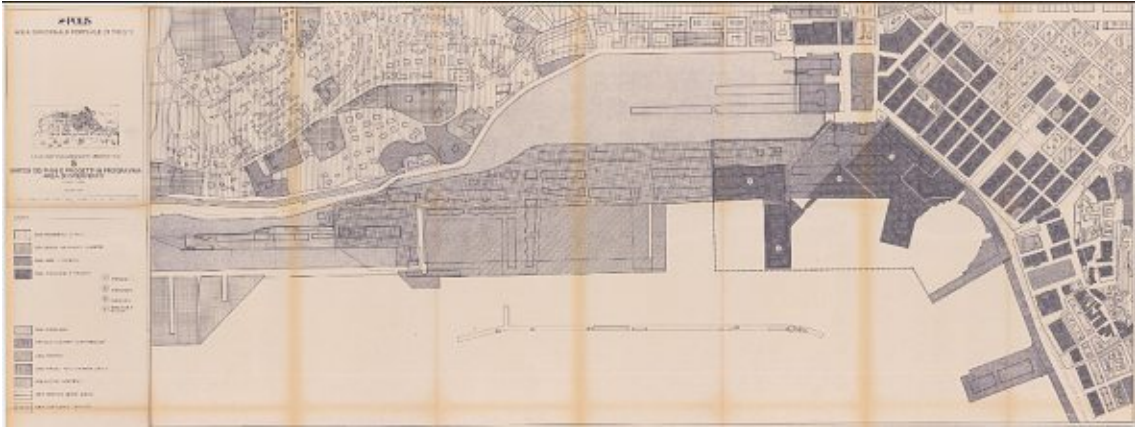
Lageplan des vom Masterplan „Progetto Polis“ betroffenen Areal. Nicolò Savarese, 1988.
